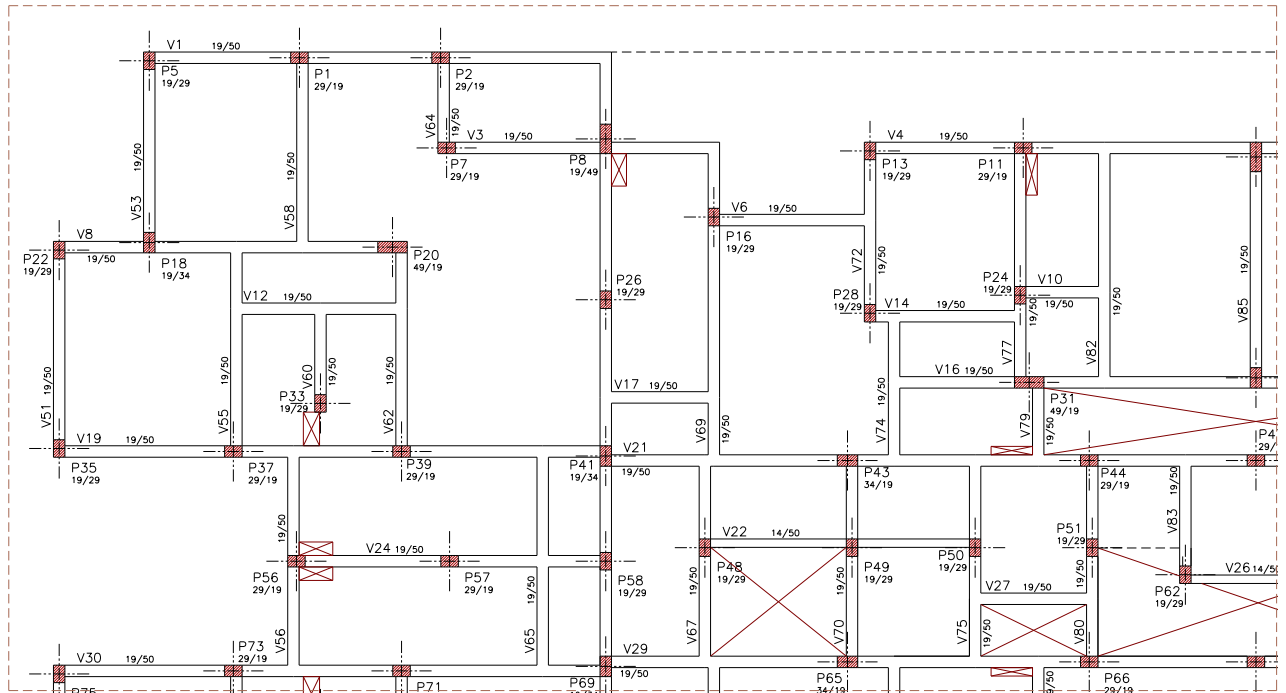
Edifício Way Penha: detalhe da planta de formas do 1º pavimento
